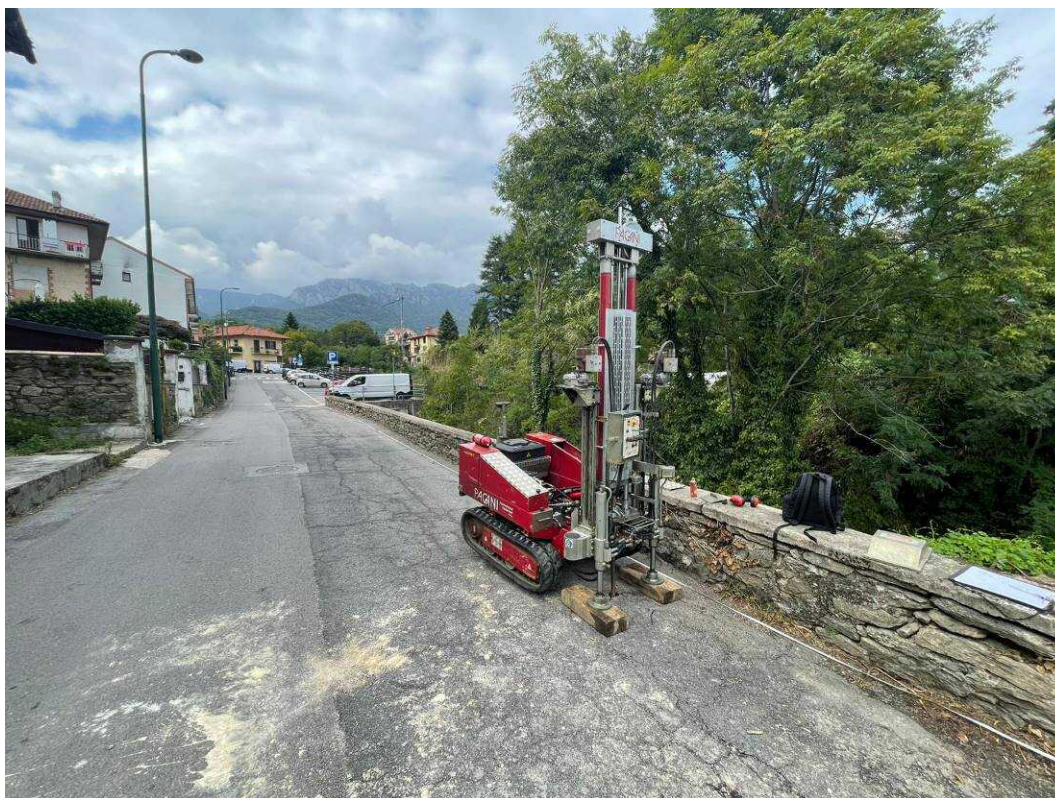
L'esecuzione della prova penetrometrica DPSH 3
